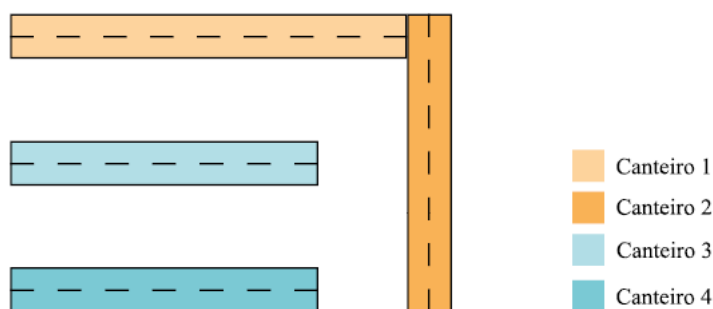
Planta dos canteiros elevados da horta pedagógica.
